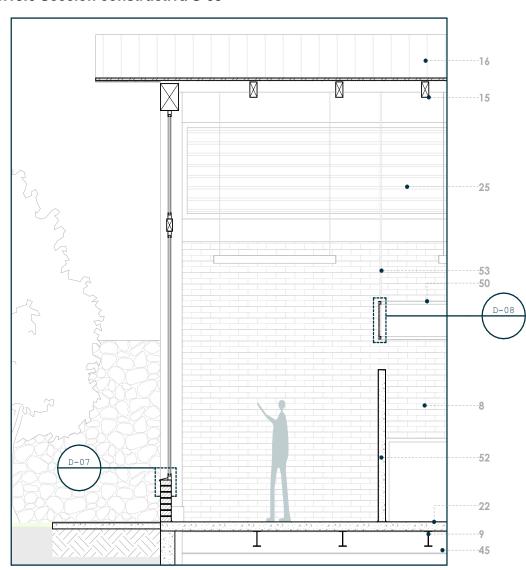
Escantillón S-05 Esc_1:50. Fuente: Autores, 2024
